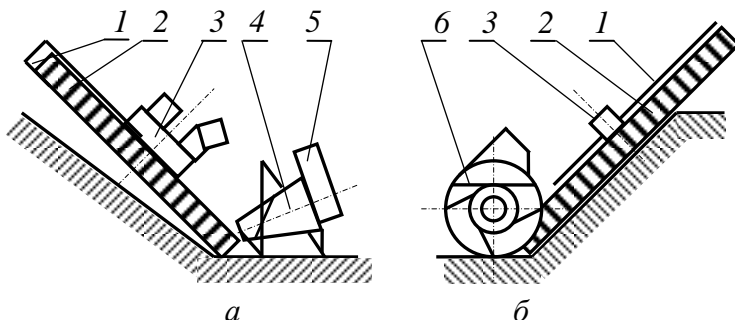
Схема комбинированных рабочих органов: а – шнеко-фрезерного с коническим шнеком; б – двухфрезерного.
